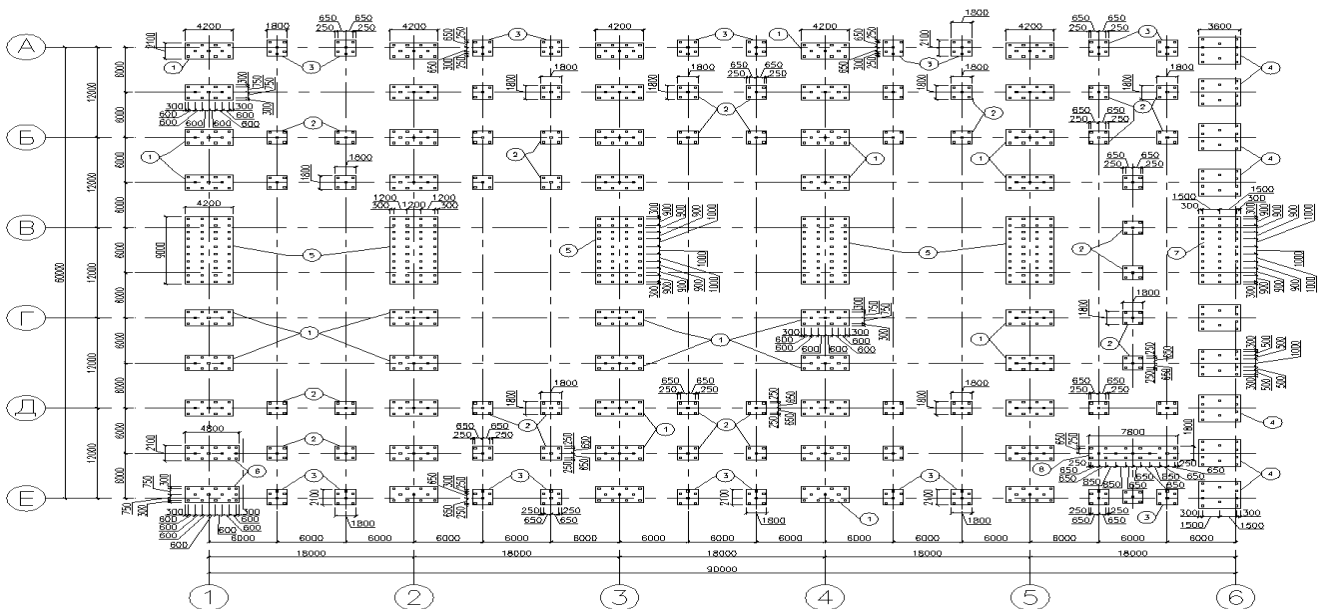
Схема расположения ростверков фундаментных конструкций блока мастерских (БМ) спецкорпуса на плане
